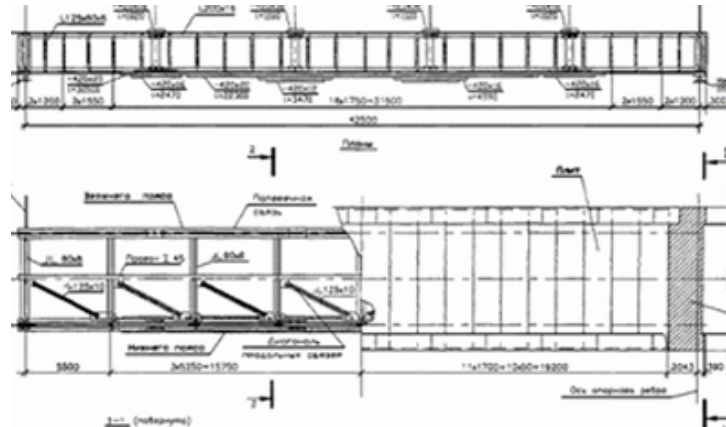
Конструкция сталежелезобетонного перекрытия с легкобетонными вкладышами.
